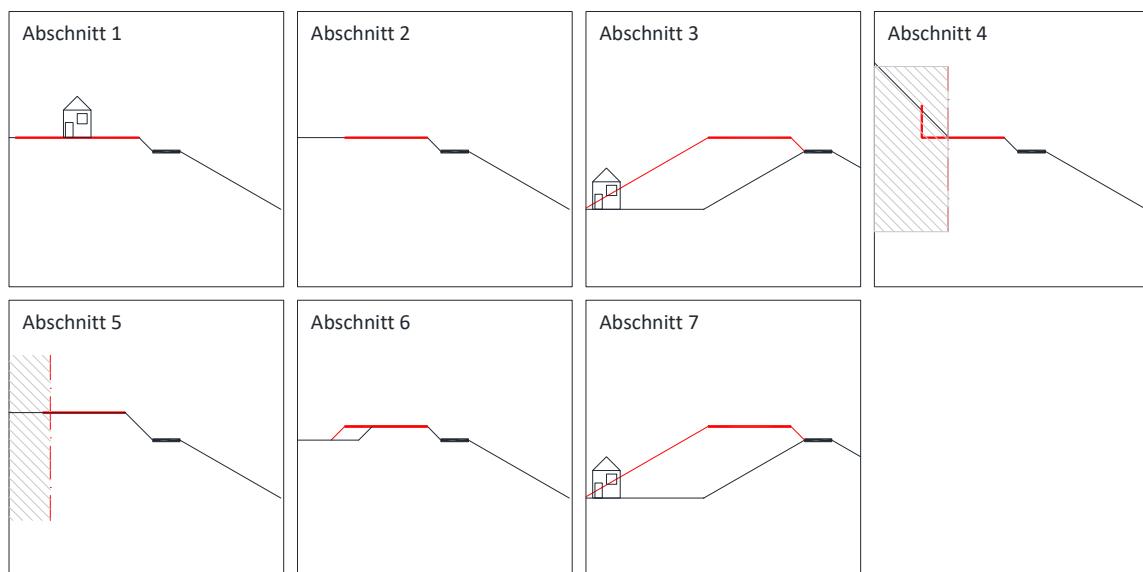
Trasse T1, Querschnitt T1.4
